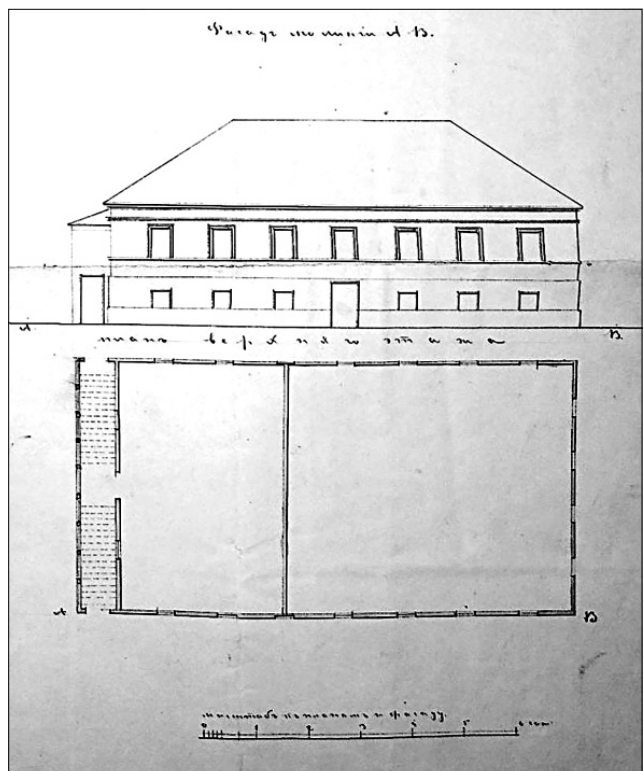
Кресленник єврейського молитовного будинку (фрагмент). Фасад по лінії АВ і план верхнього поверху [4, арк. 38]
